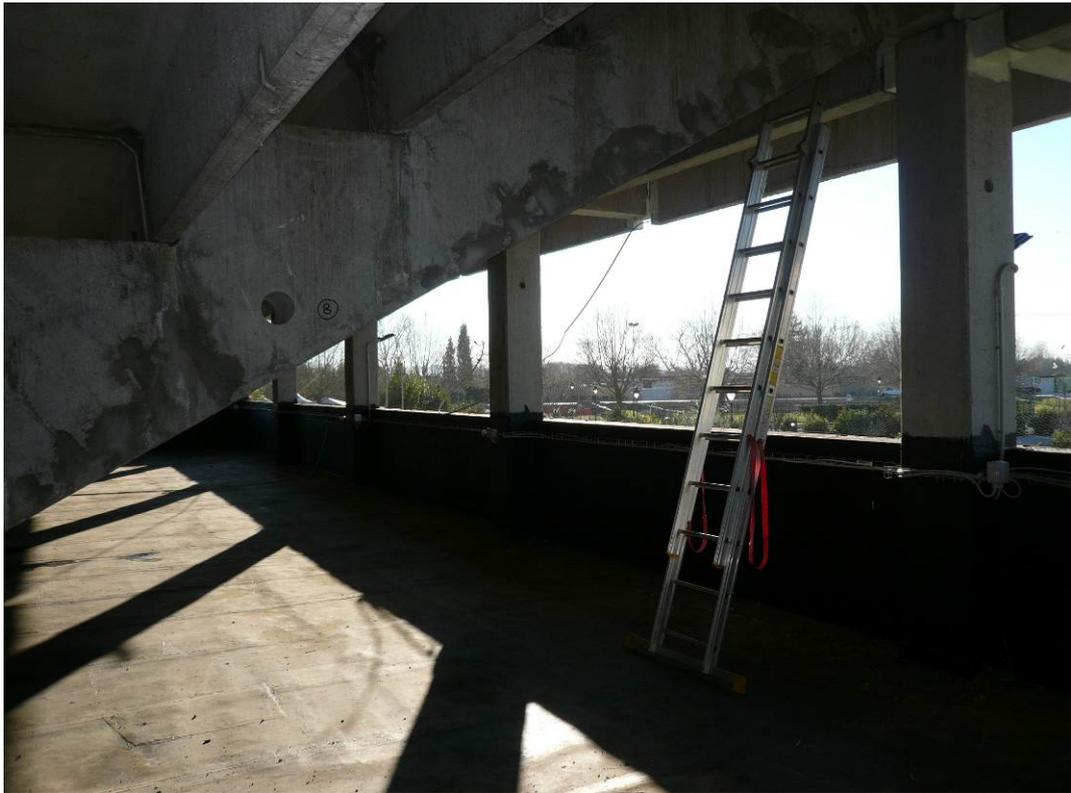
Interventi su parti in calcestruzzo armato, e nei collegamenti in acciaio tra trave e pannelli
